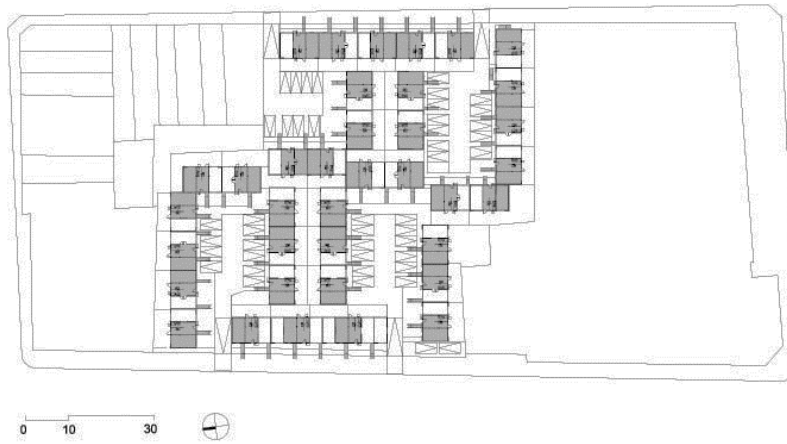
Planta general del proyecto. Fuente: sitio web Archdaily
